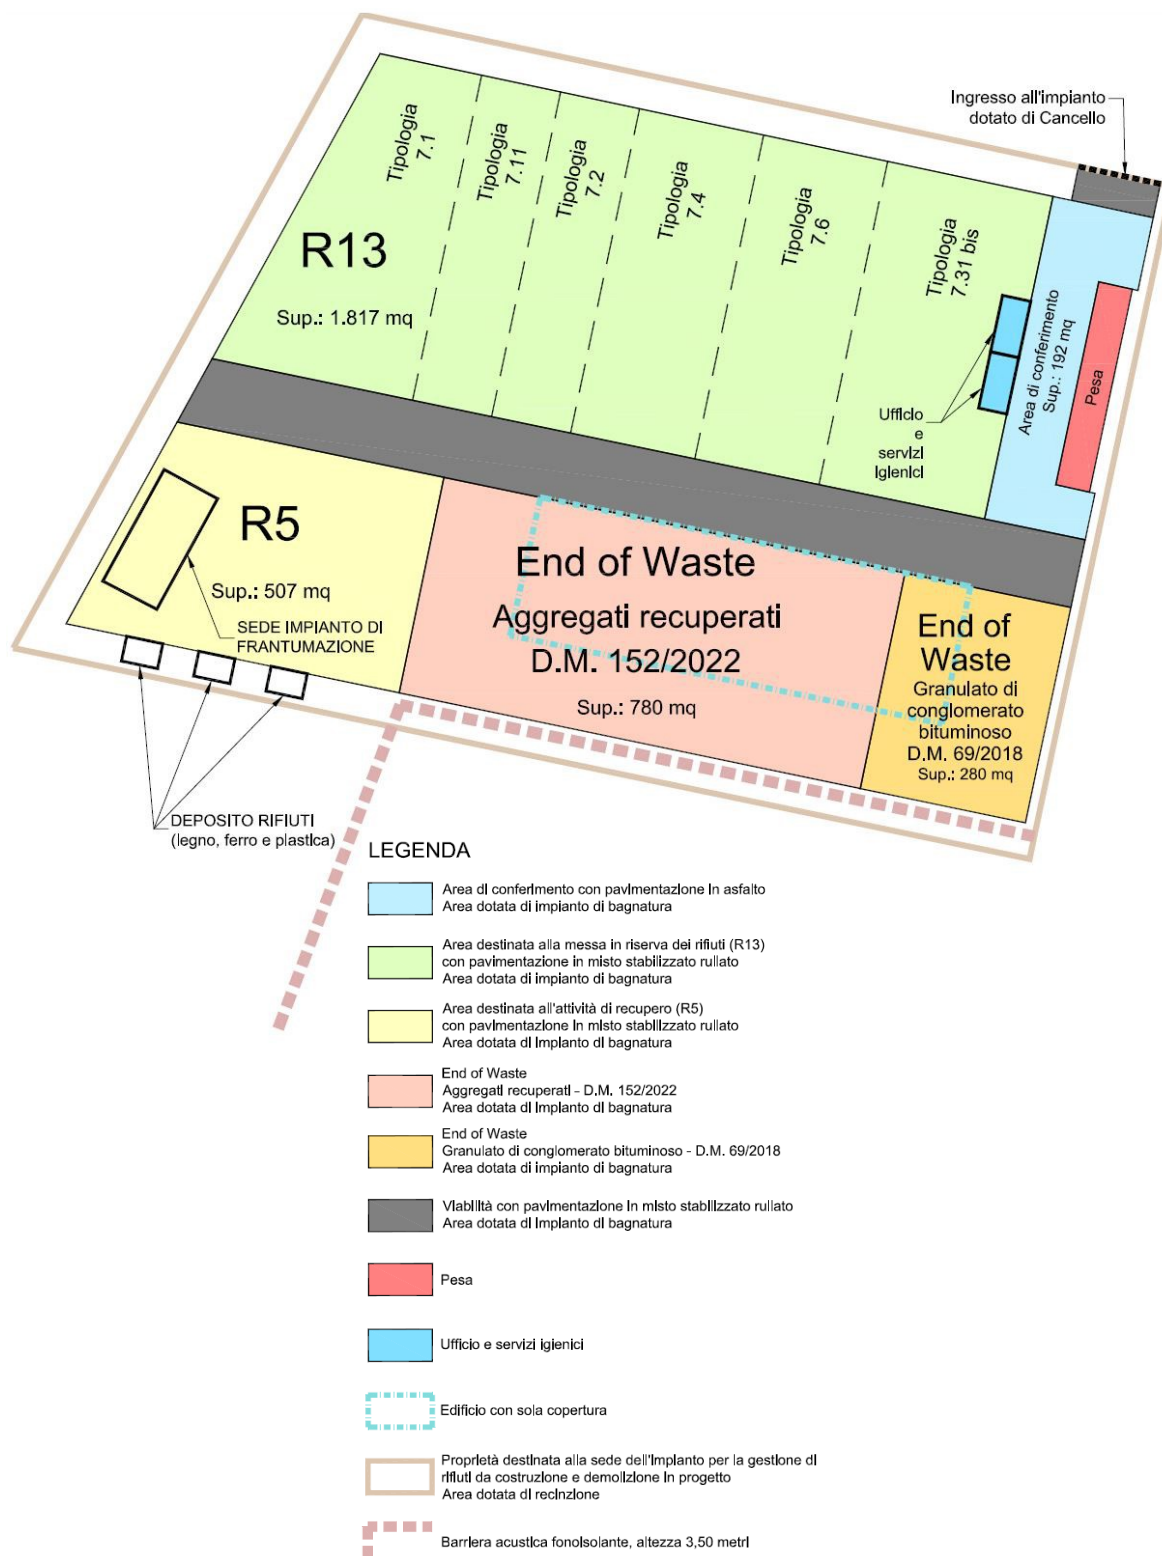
Schema planimetrico dell'impianto per la gestione di rifiuti da costruzione e demolizione in progetto.
